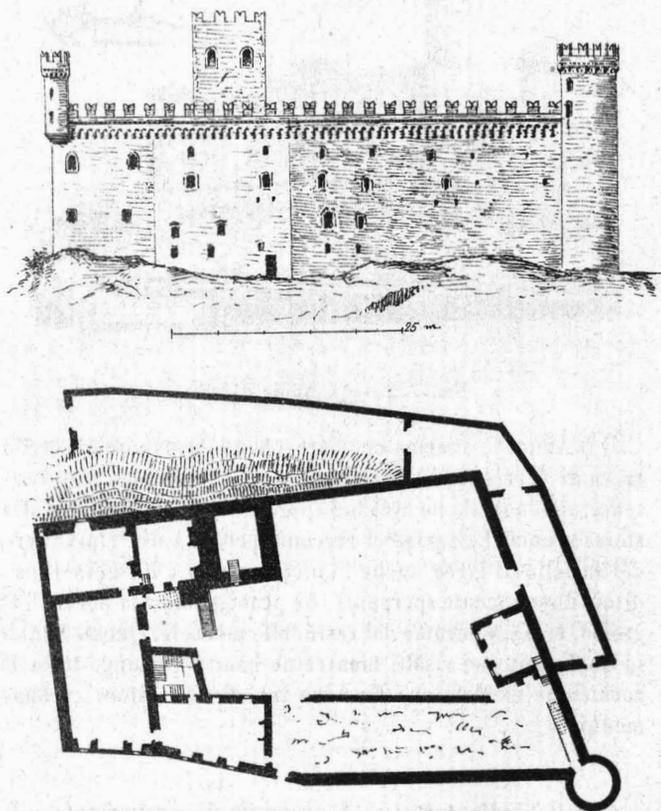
e 124. — Prospetto e pianta del castello di Montalto.
